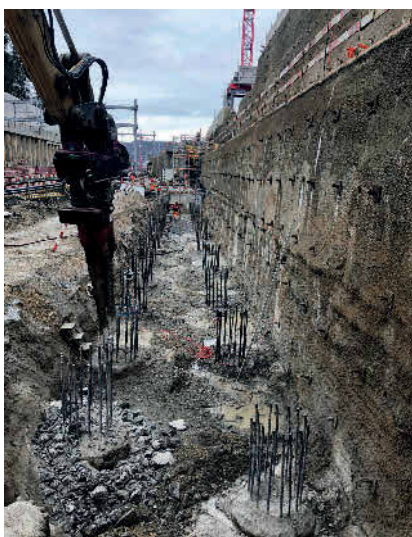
Ausbrechen des Restbetons mit dem BRC Pfahlkopfbeißer Foto: BRC Engineering
